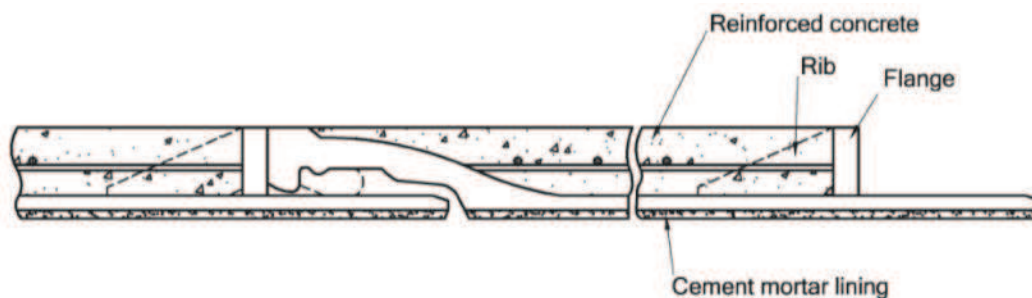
Esquema de junta tipo TD para tubos de ferro fundido dúctil – DN 300-1600 mm (KUBOTA 2007)
